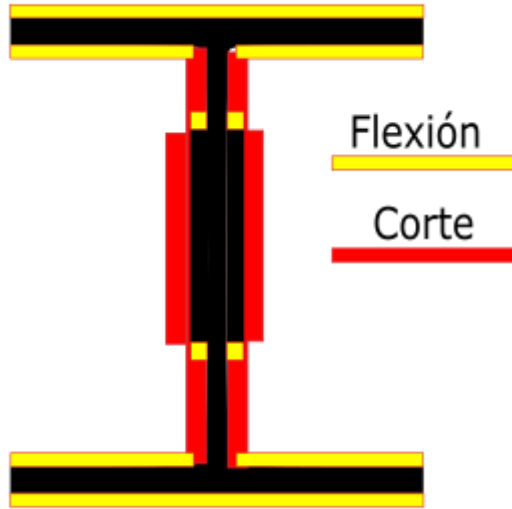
Esfuerzos en la soldadura Caso 02
